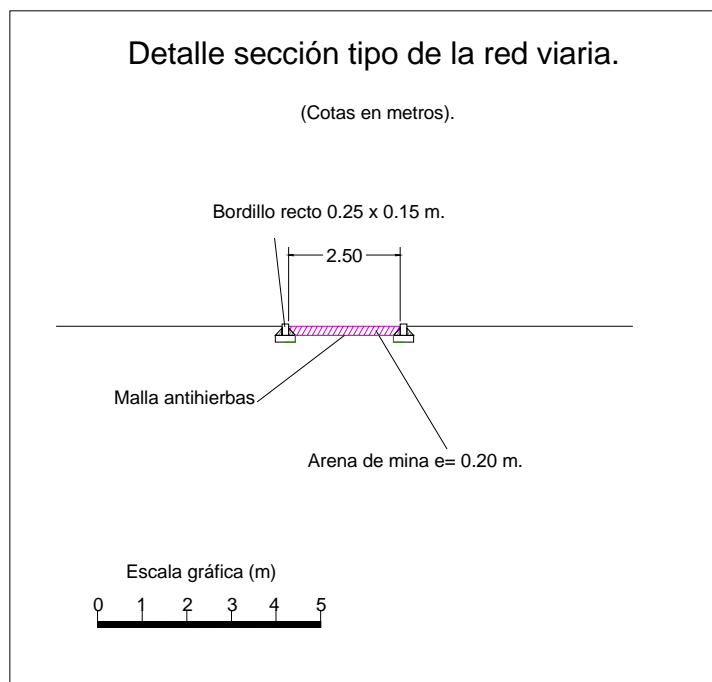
Detalle de la sección tipo de la alternativa 1 de la red viaria en el interior de "Las Caballerizas".
